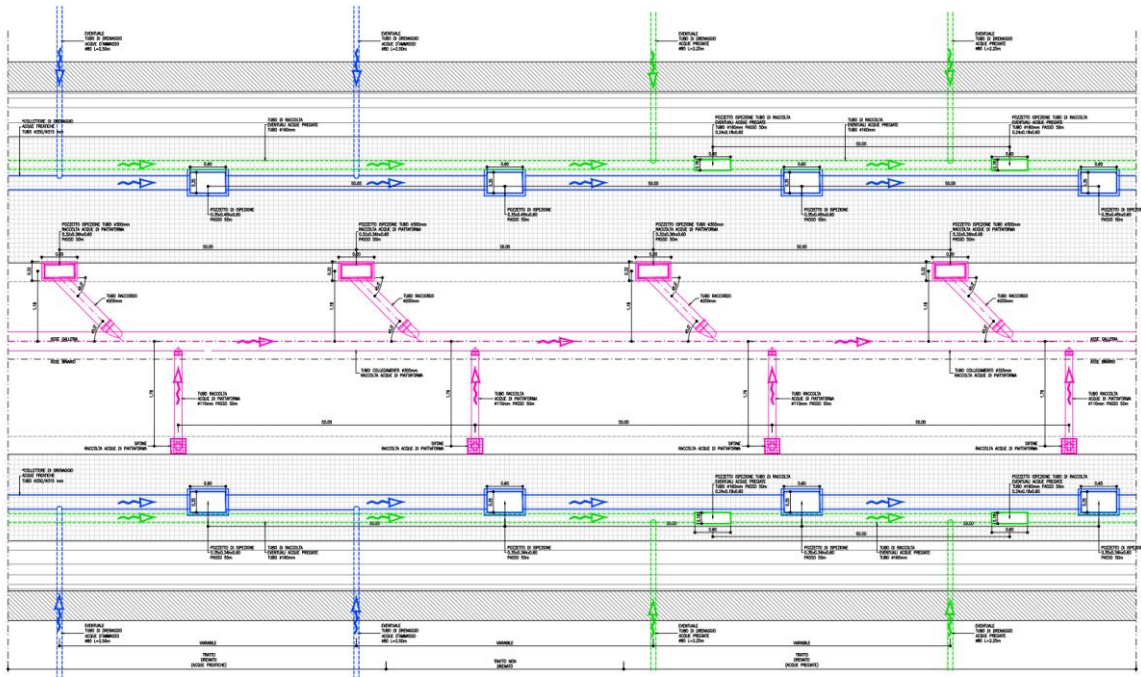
Stalcio planimetrico della rete di smaltimento acque – Scavo meccanizzato
